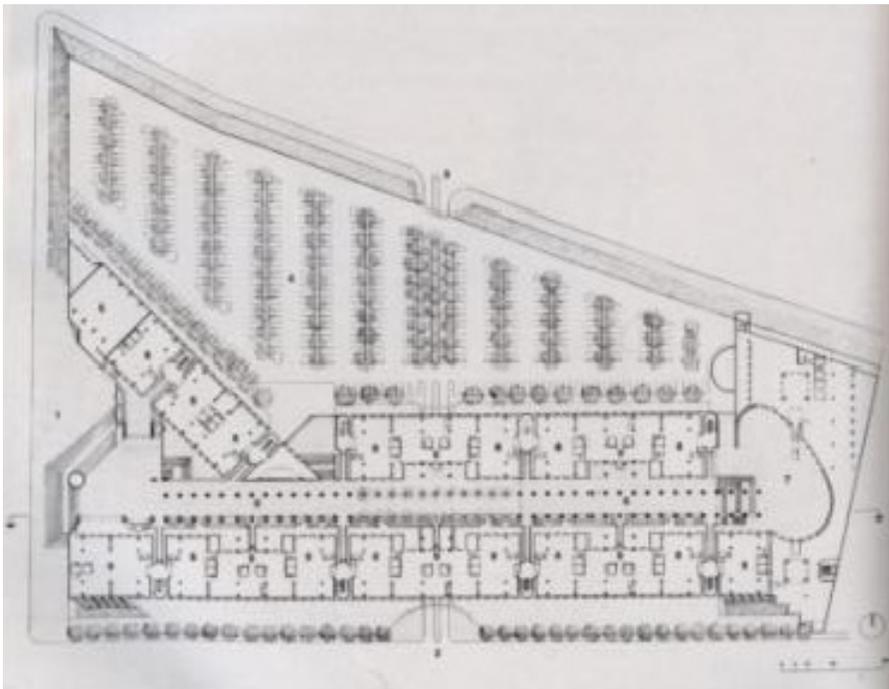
Planta de Conjunto. Fuente: Archivo AINDABIIN.
